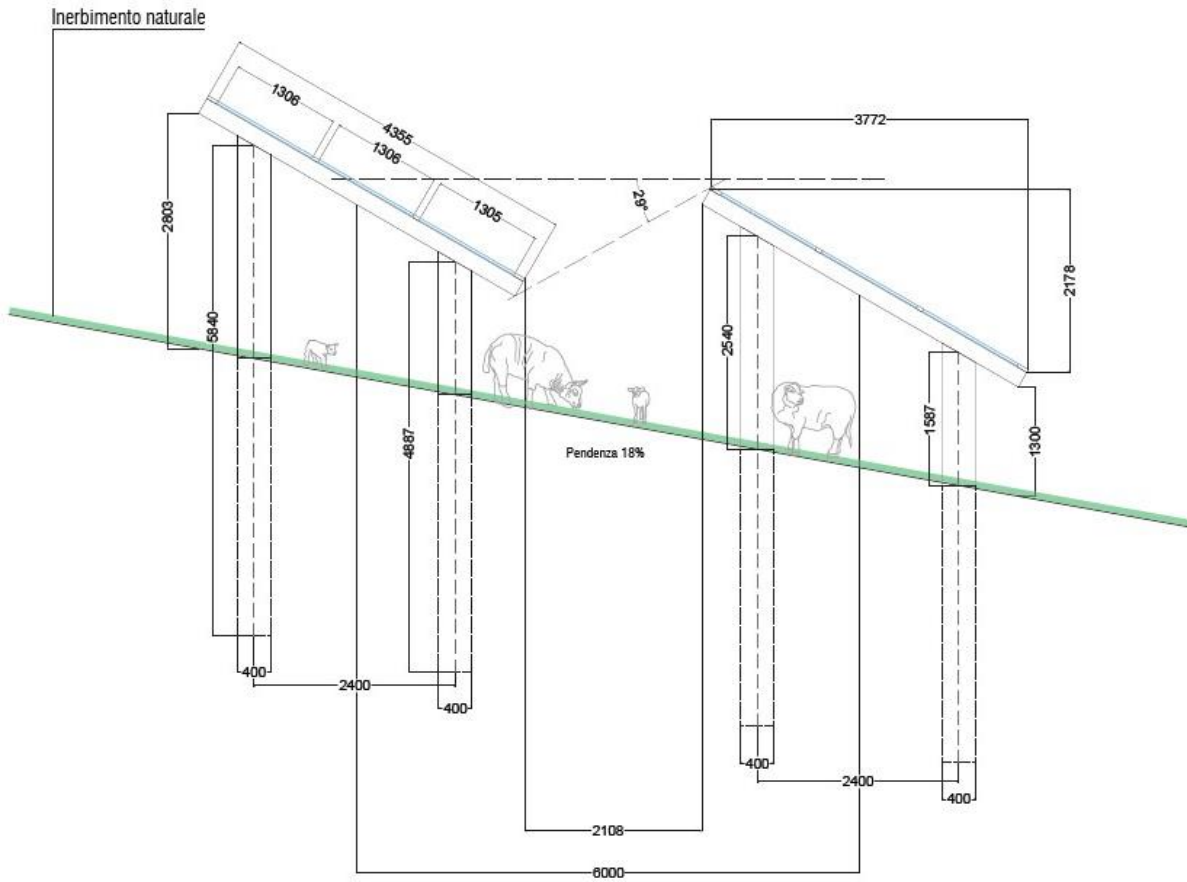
Sezione trasversale stringhe a telaio fisso in area ad attività zootecnica
